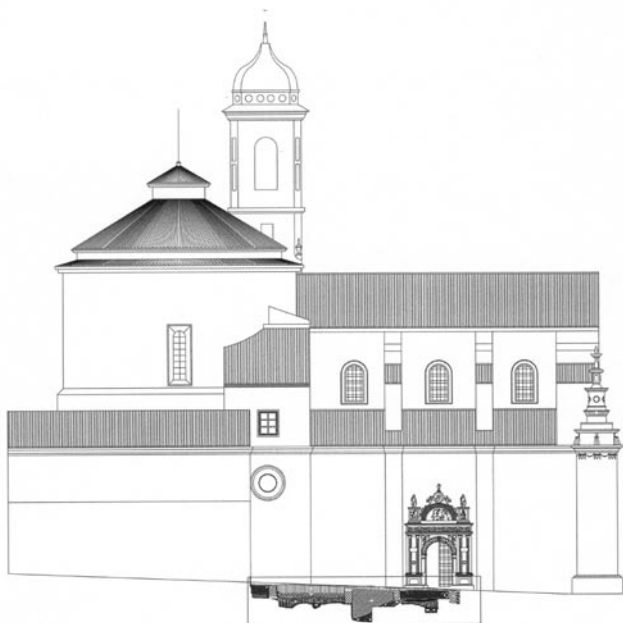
Proyección de la estratigrafía en el alzado norte de El Salvador.
